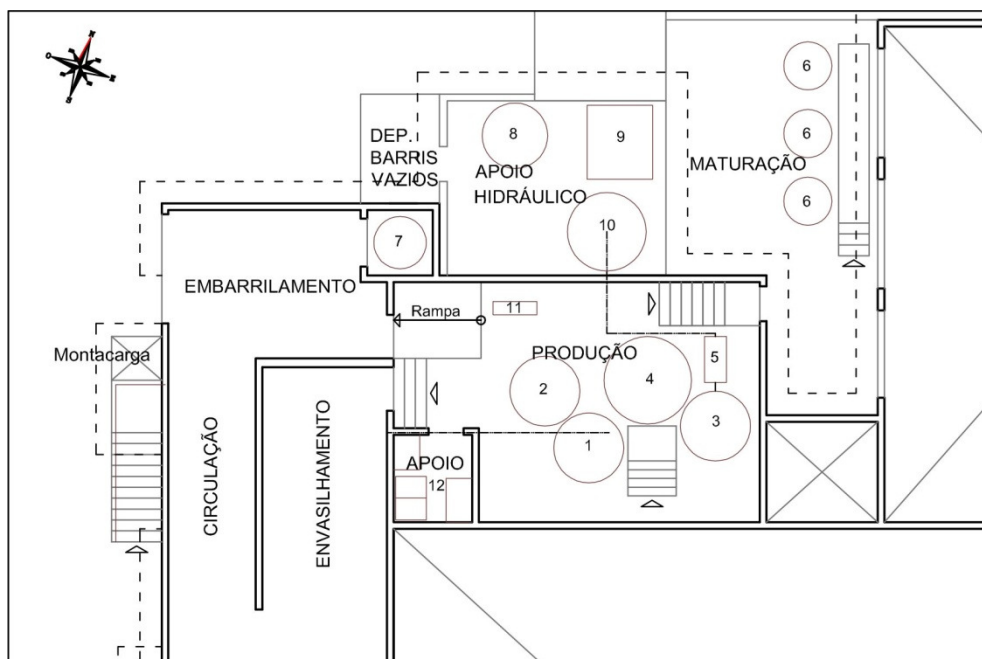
Planta esquemática do pavimento térreo: fábrica e bar (Escala 1:250)
